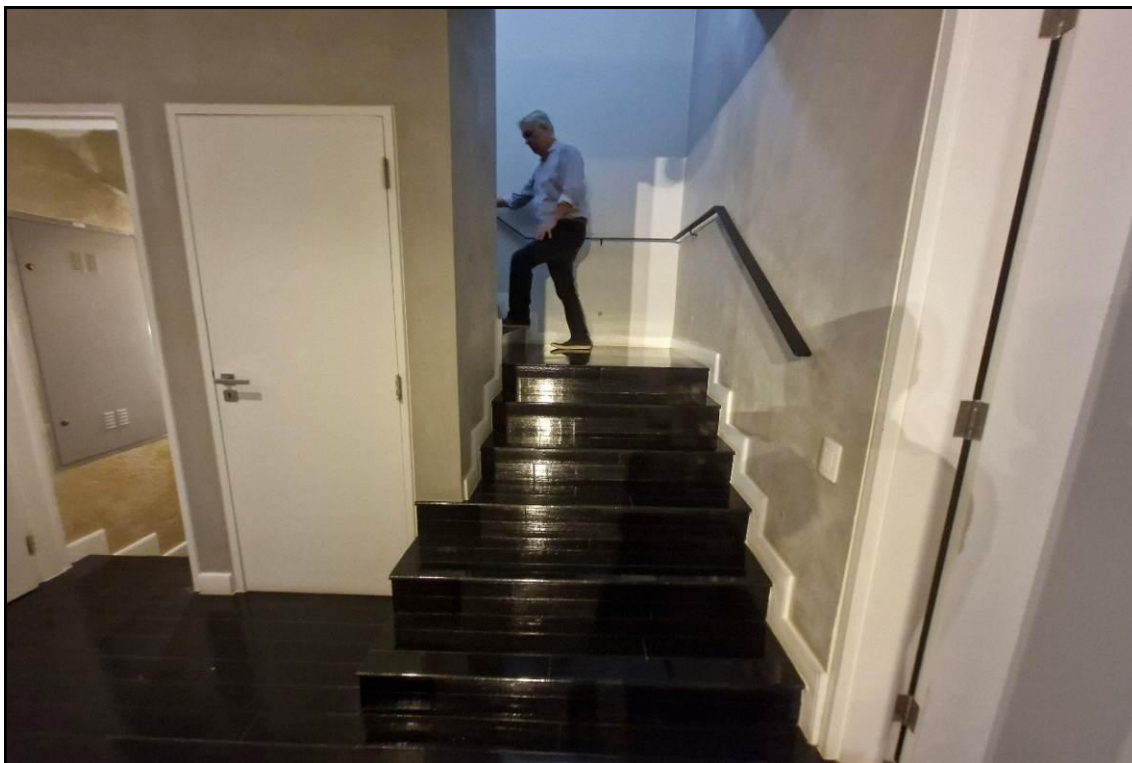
Escadaria de acesso ao pavimento superior da edificação principal.
